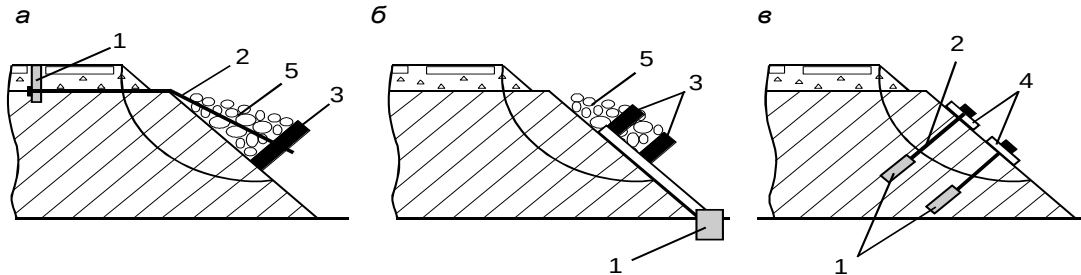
Схемы анкерных конструкций крепления слабых откосов: а, б – камень для пригруза откосов; в – усиление в тяжах пригрузом; 1 – анкер; 2 – тяж; 3 – элементы из железобетона для удержания камня на откосе; 4 – железобетонные плиты; 5 – камень
